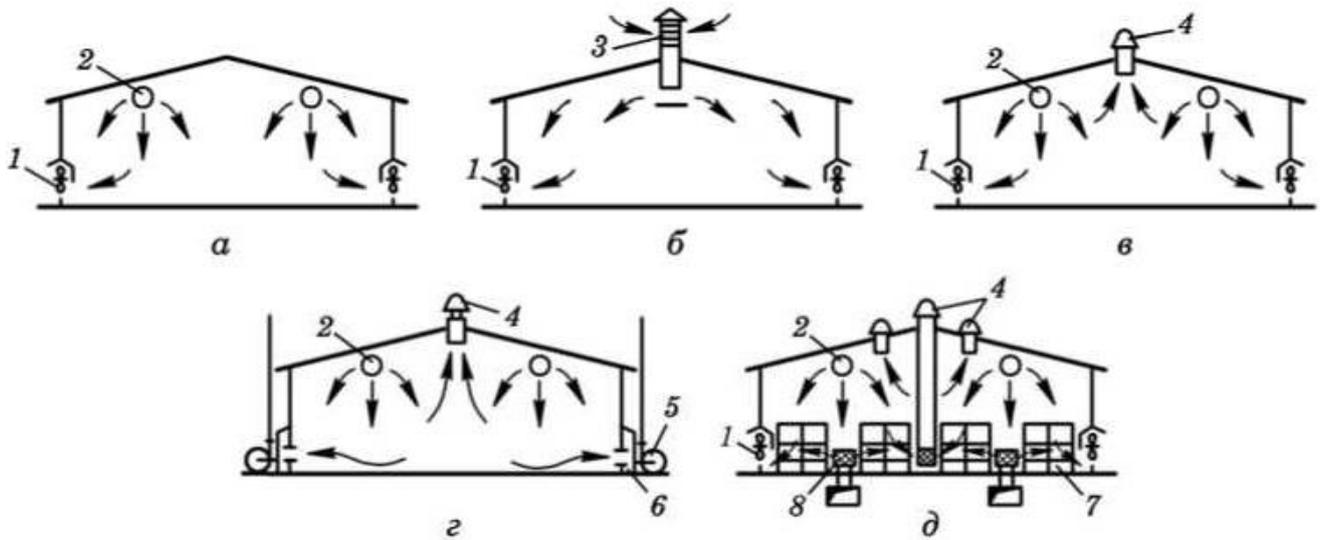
Схемы вентиляции в птицеводческих помещениях:
